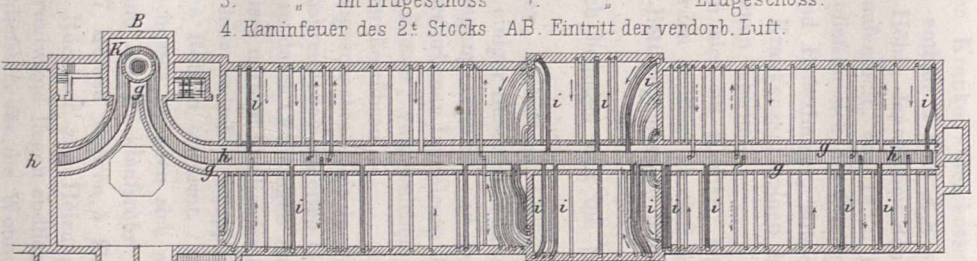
Grundriss des Dachgeschosses, nach A.B. Fig. 8.
